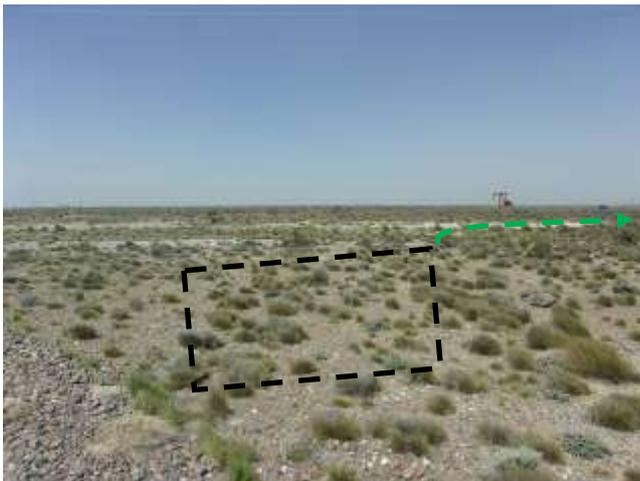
Vértice SO de la locación existente (verde) y lateral Oeste de la locación propuesta (rojo), como se observa no requerirá ampliación. Foto en dirección E.
